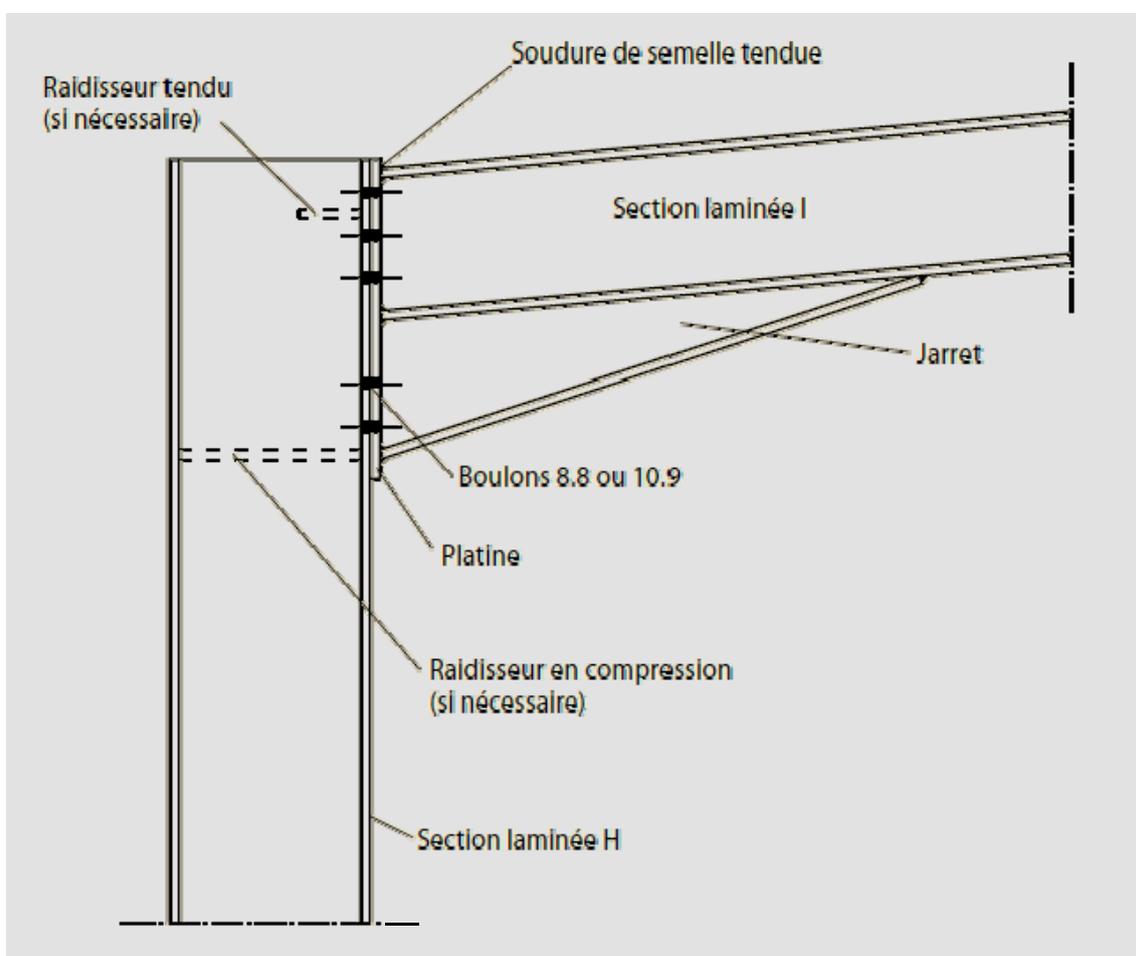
Assemblage typique poteaux-poutres dans un portique
